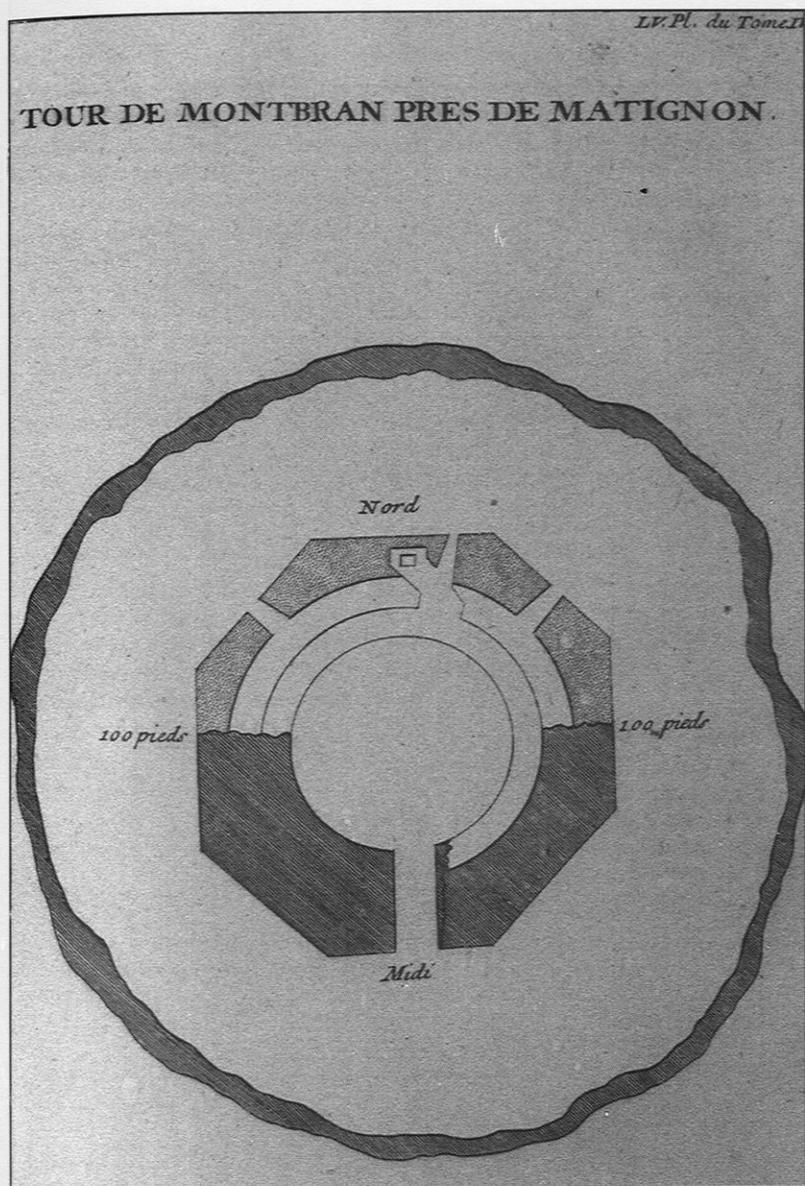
Plan de la tour de Montbran en Pléboulle,
